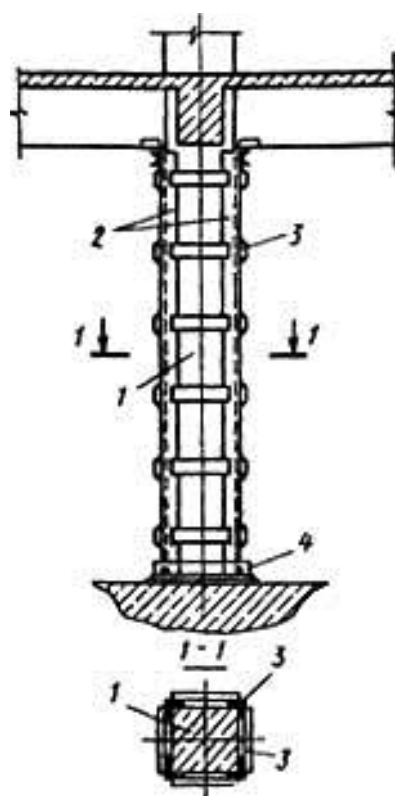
Усиление колонны металлическими обоймами: 1 – усиливаемая колонна; 2 – ветви обоймы; 3 – планки обоймы; 4 – опорный уголок
